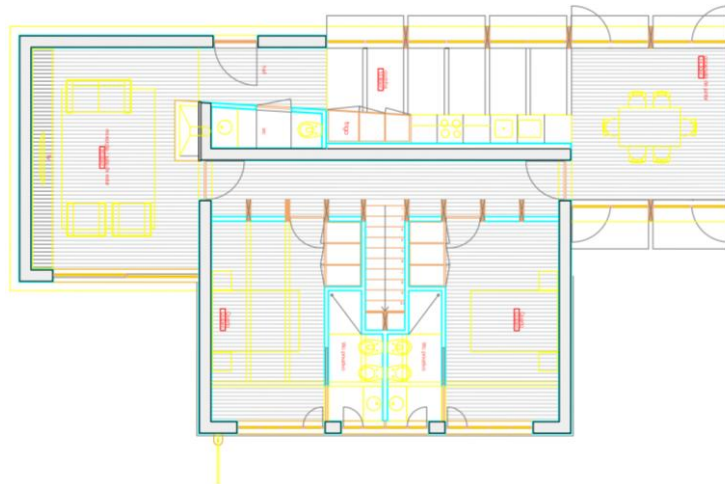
| Planta Piso Térreo, Garafim, Casa da Antiga Escola, Arq. André Rocha, 2020
